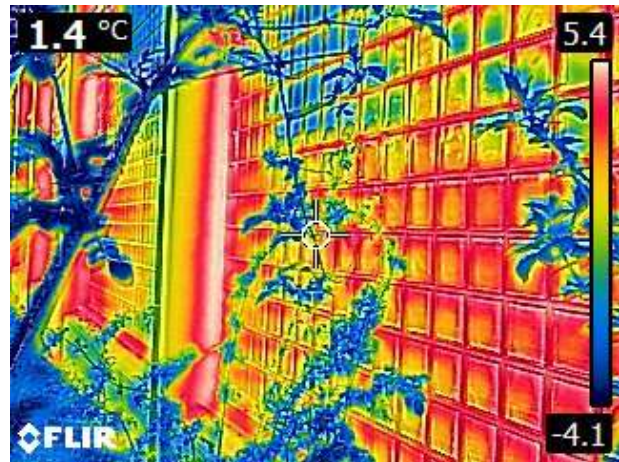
Thermografie, ungedämmte Stahlbetonbauteile
